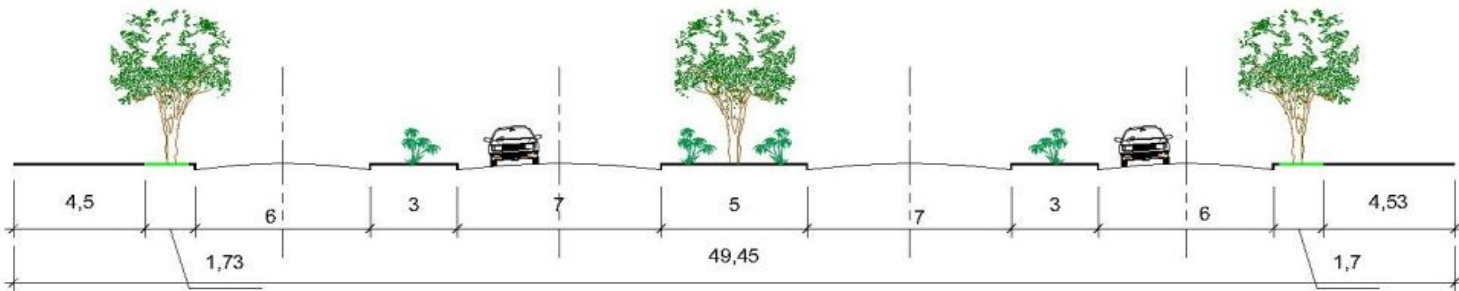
Sección de calle distribuidora primaria ancho de vía 40-100 metros.
